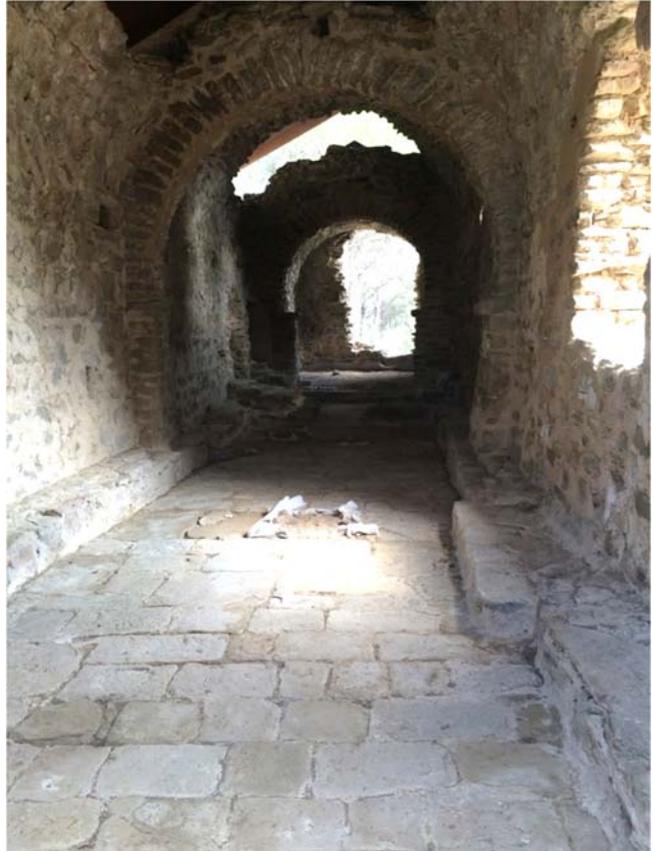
Pavimento de losas de piedra en Sant Romà de Sidillà y banquetta perimetral. Fotografía de M. Valls Mora.
